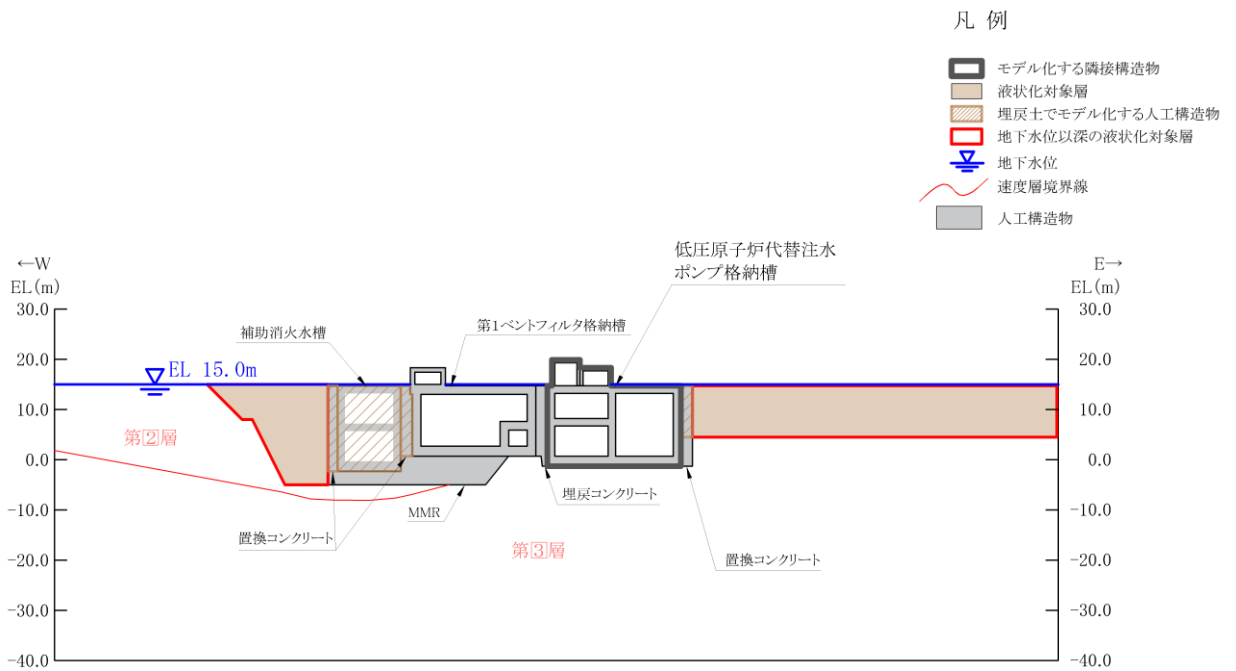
低圧原子炉代替注水ポンプ格納槽 断面図 (C-C 断面位置)
